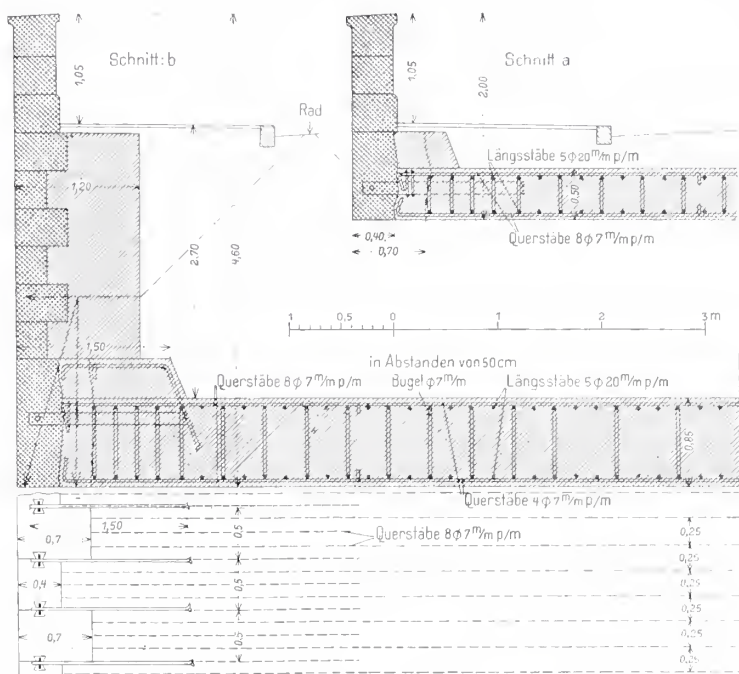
Querschnitte a und b und Armierungsplan. — 1:75.
